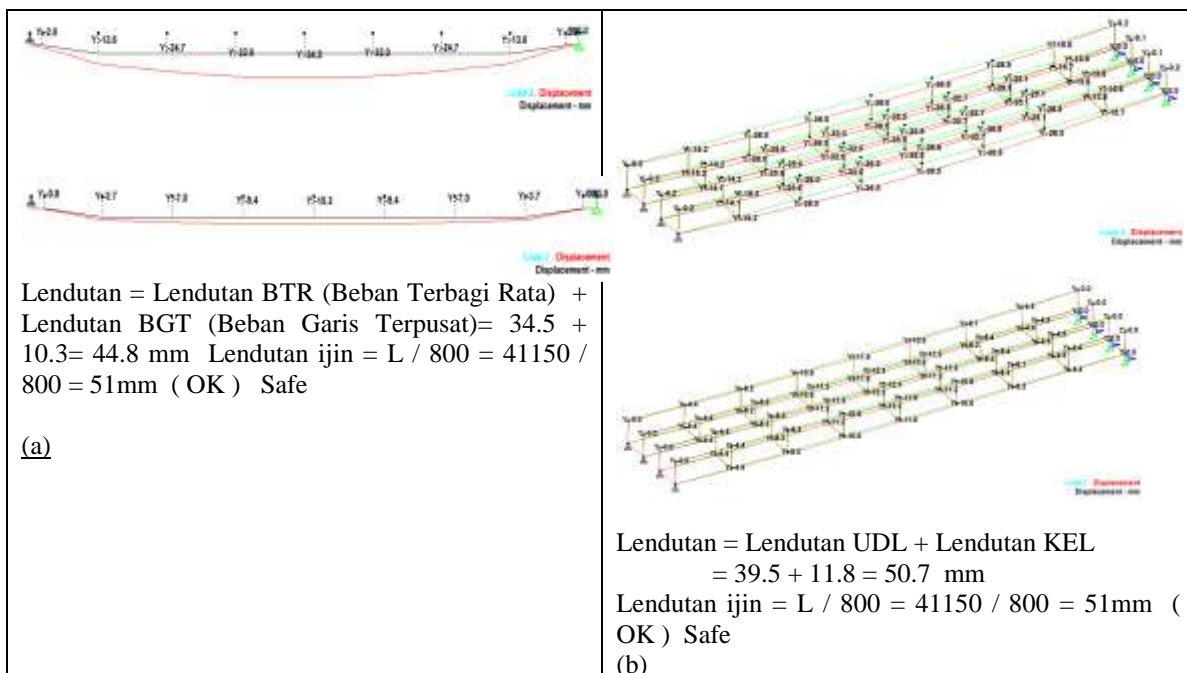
Pemilihan Profile Struktur Gelagar I dan Box girder
